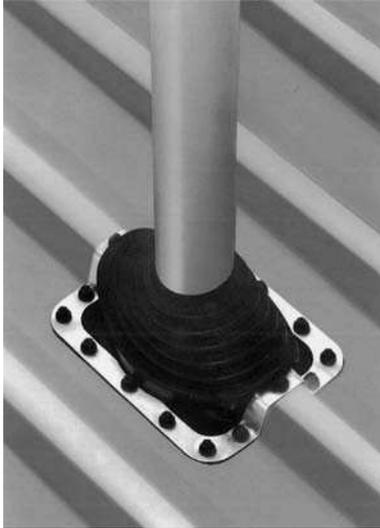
Abdeckungen an Rohrdurchführungen bei Well- oder Trapezprofilen
